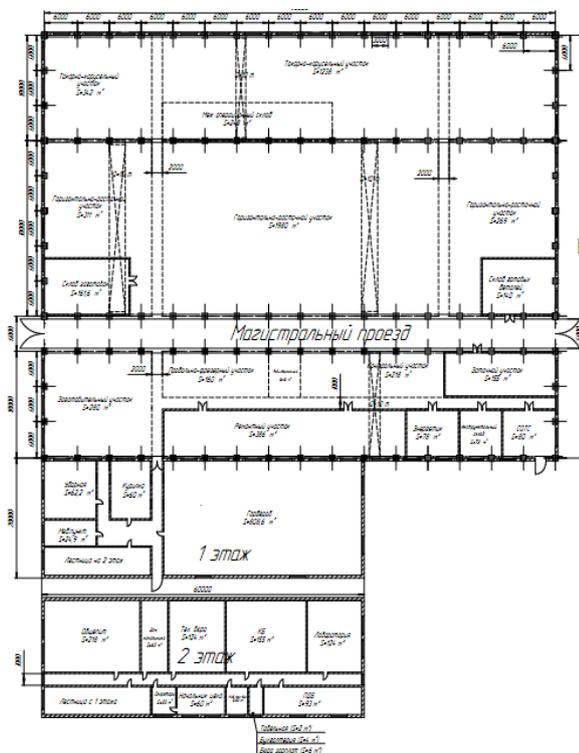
Планировка механосборочного цеха АО «Тяжмаш»
